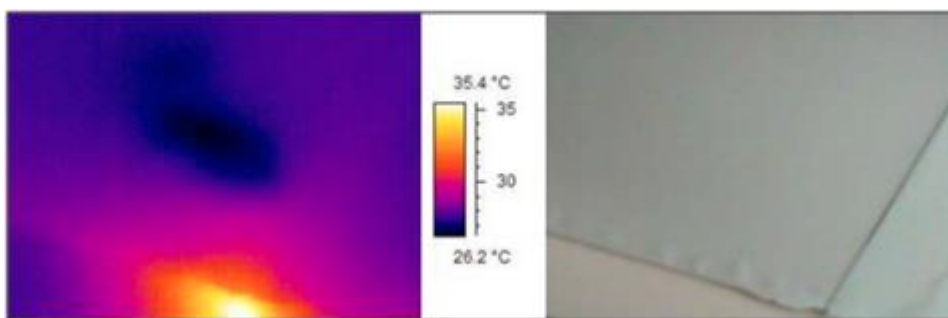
Fissuração em fachada com revestimento argamassado.
